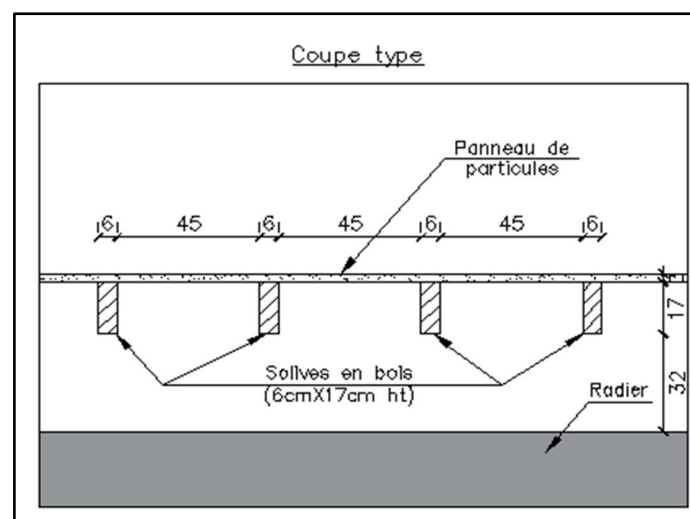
Coupe type du plancher bas du RDC EXISTANT
